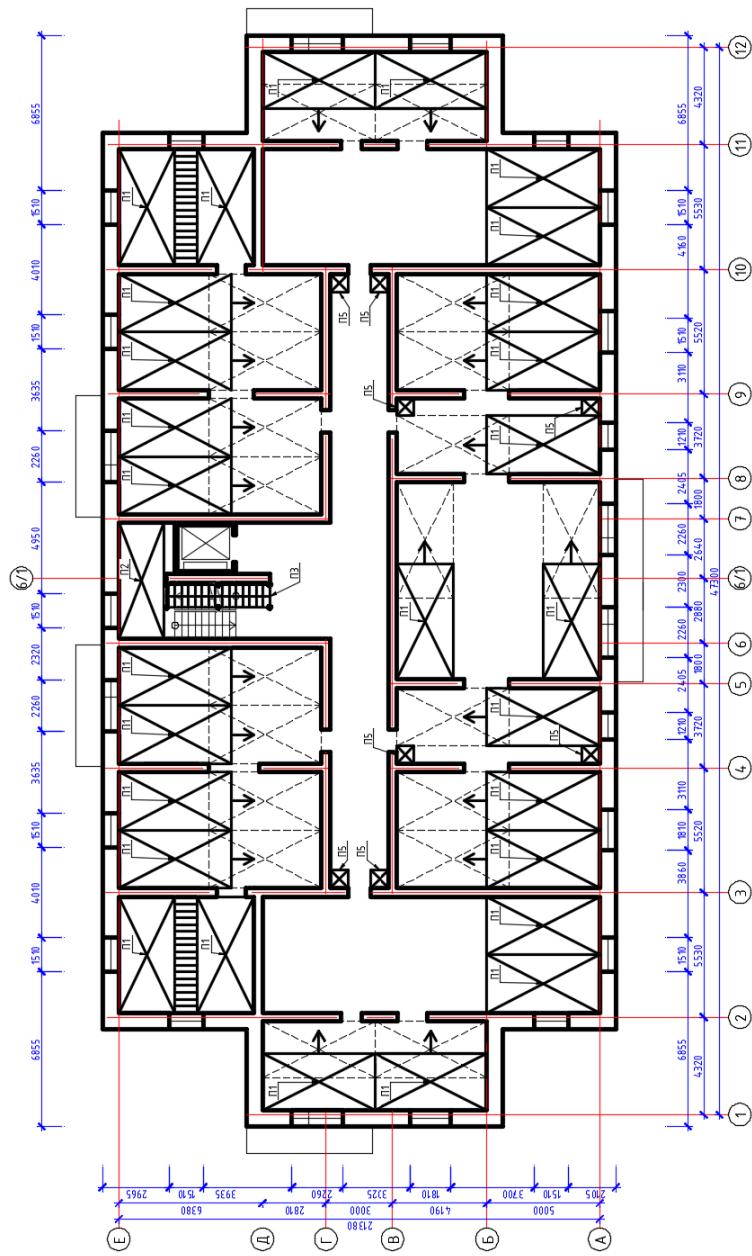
Схема установки подмостей при кладке наружных и внутренних стен
